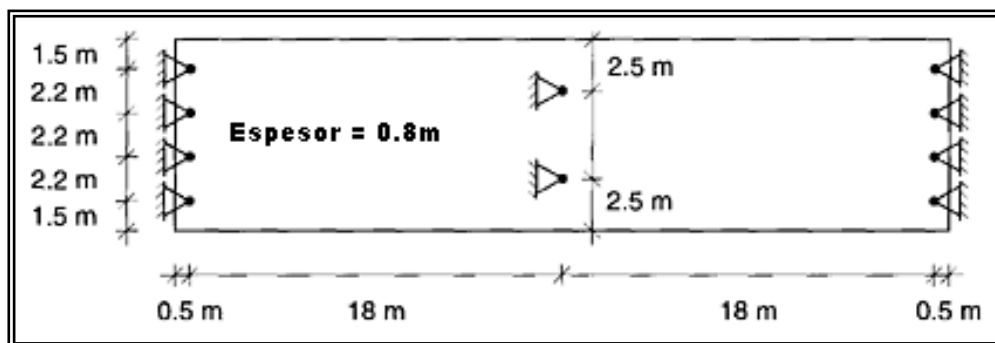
159 Vista en planta de puente tipo losa de dos claros¹⁷³.
